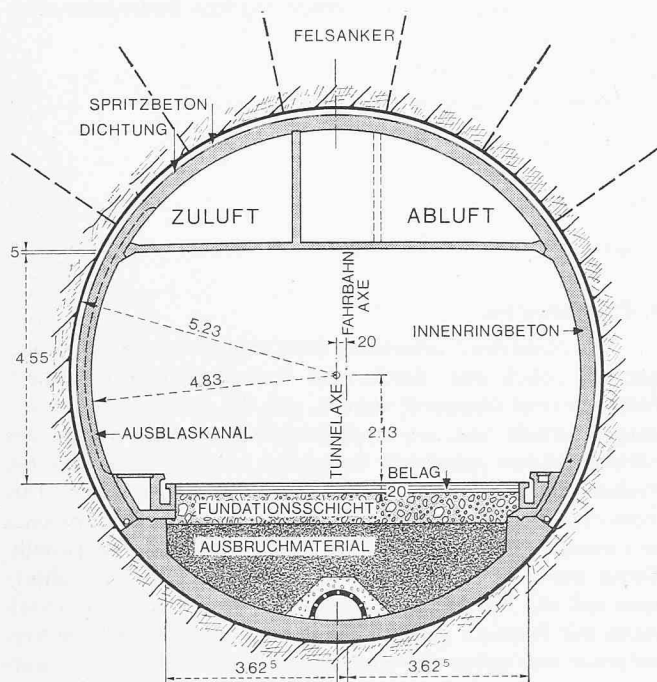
Normalprofil des Sonnenbergtunnels, aus [4]
